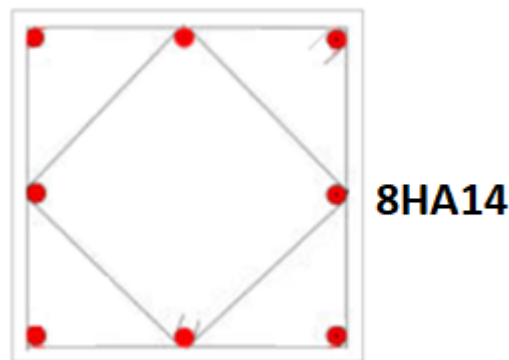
Schéma de ferrailage des poteaux de section 35 X 35 cm
